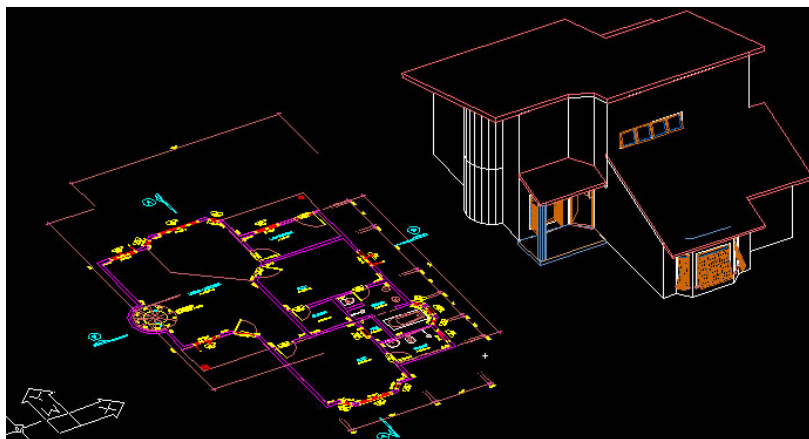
Perspectiva e planta baixa no mesmo plano de trabalho.
